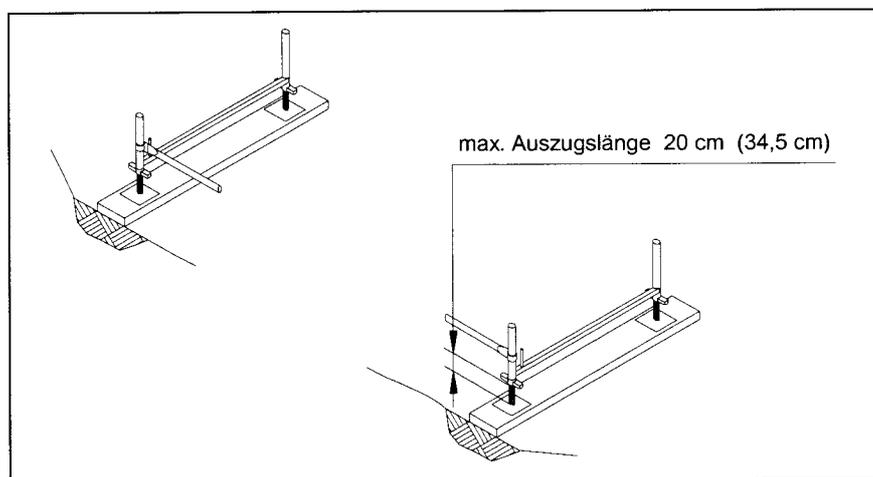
Lastverteilernder Unterbau mit Gerüstbohlen
